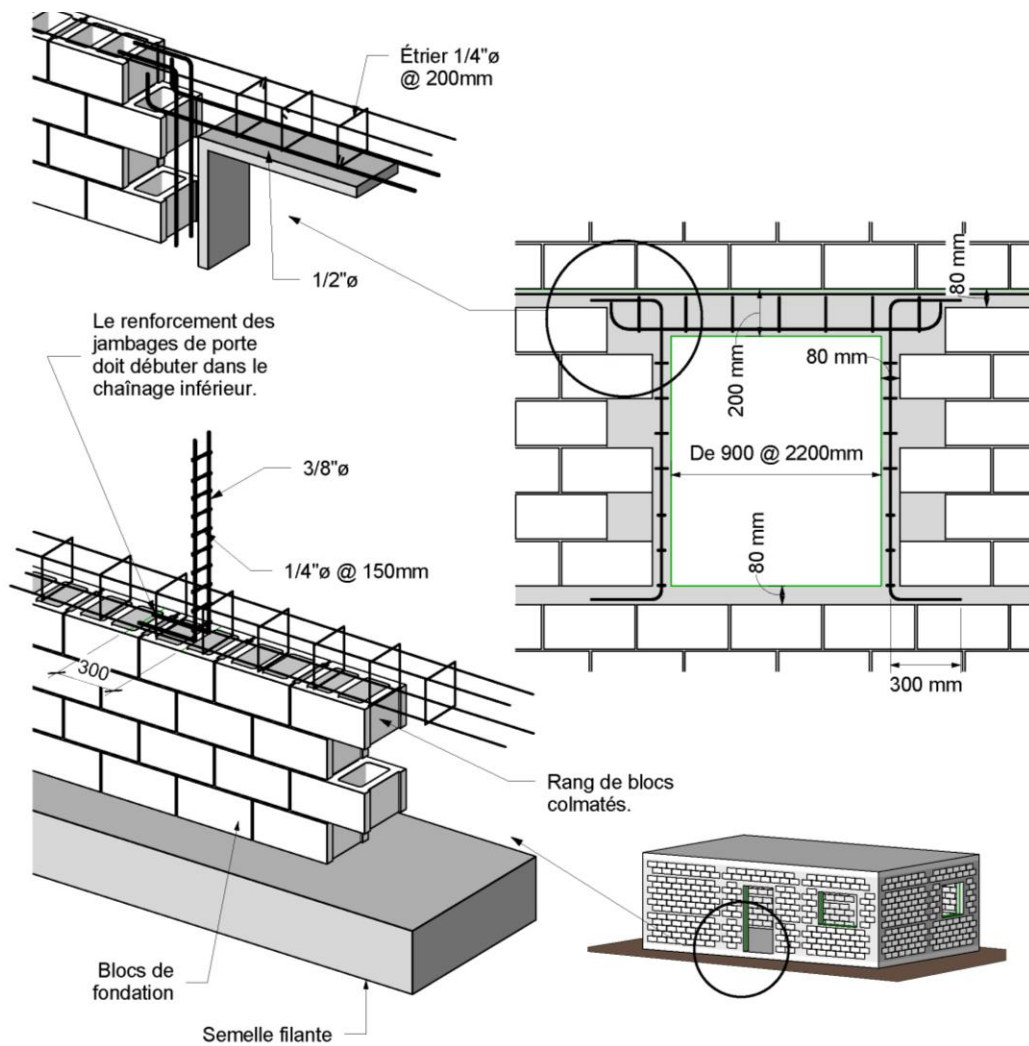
a - Ferrailage des ouvertures de grande largeur
